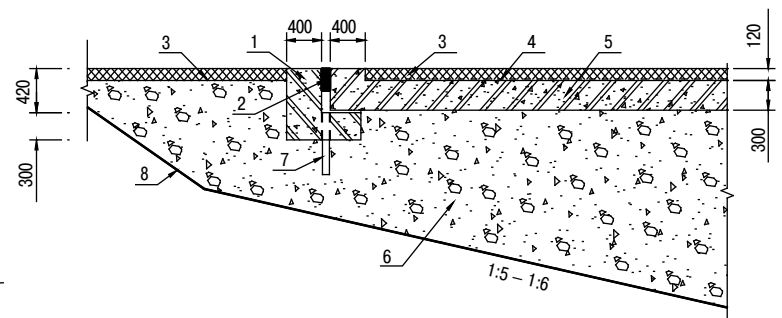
Детали конструкции сопряжения переходной плиты с лежнем: 1 – железобетонный лежень; 2 – полимерно-битумная мастика; 3 – асфальтобетонное покрытие; 4 – гидроизоляция; 5 – железобетонная переходная плита; 6 – уплотненный щебень фракции 20 мм; 7 – водоотводные трубки \varnothing 35 с шагом 2 м; 8 – геосинтетическое полотно
